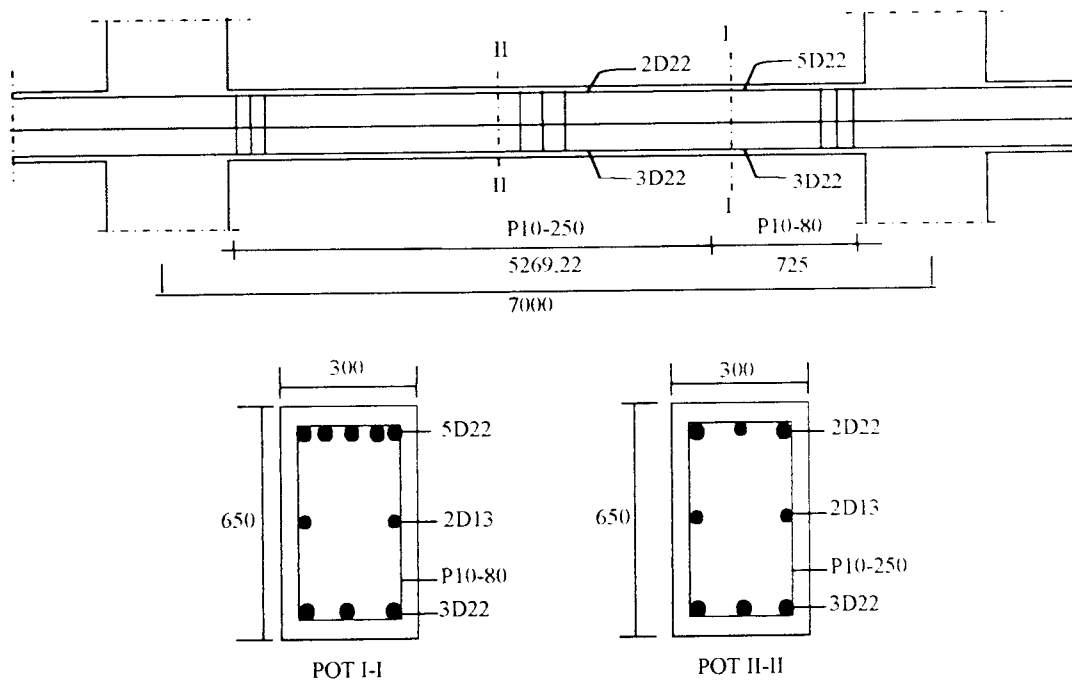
Balok Portal E Bentang 7m Lantai 7
